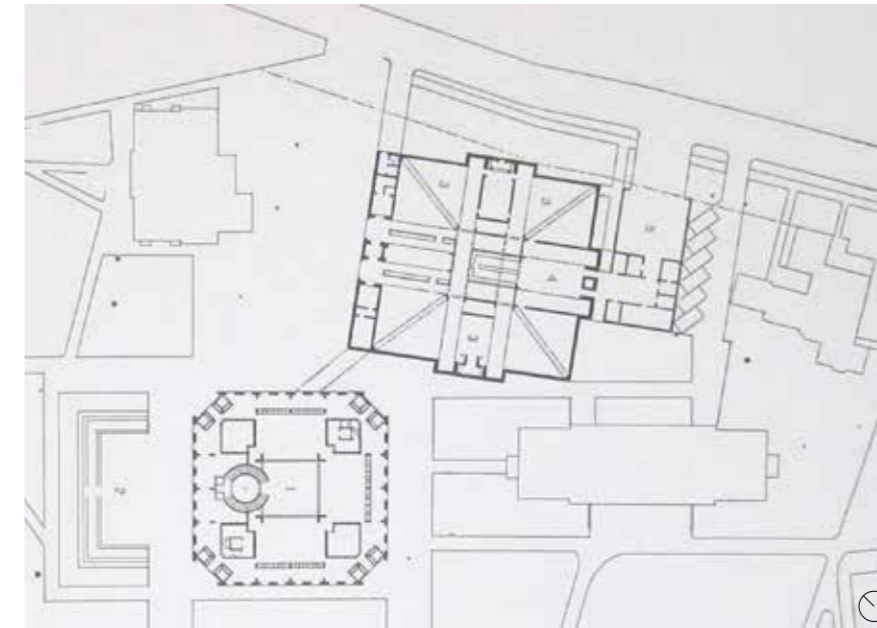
Planta de Implantação de 1967, Louis Kahn.
